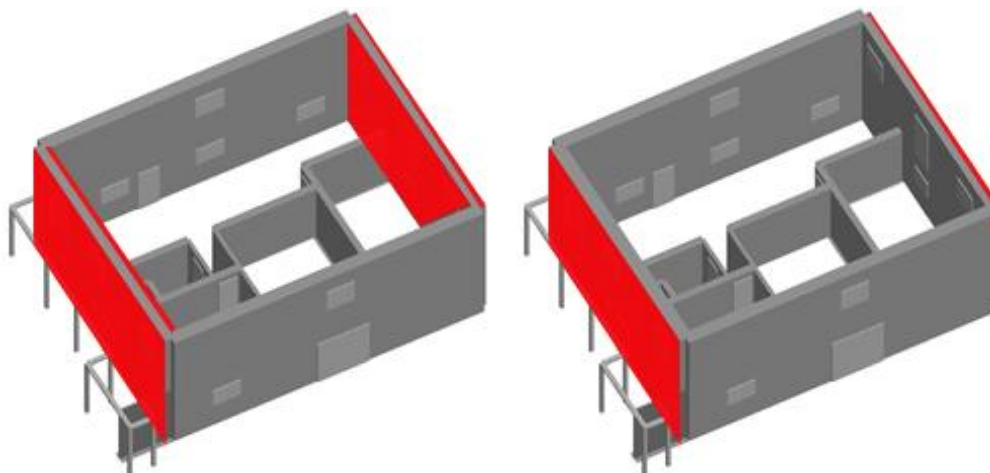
Comparação da execução de reboco armado nas duas faces das fachadas principal e de tardoiz com execução de reboco armado numa face das mesmas fachadas
